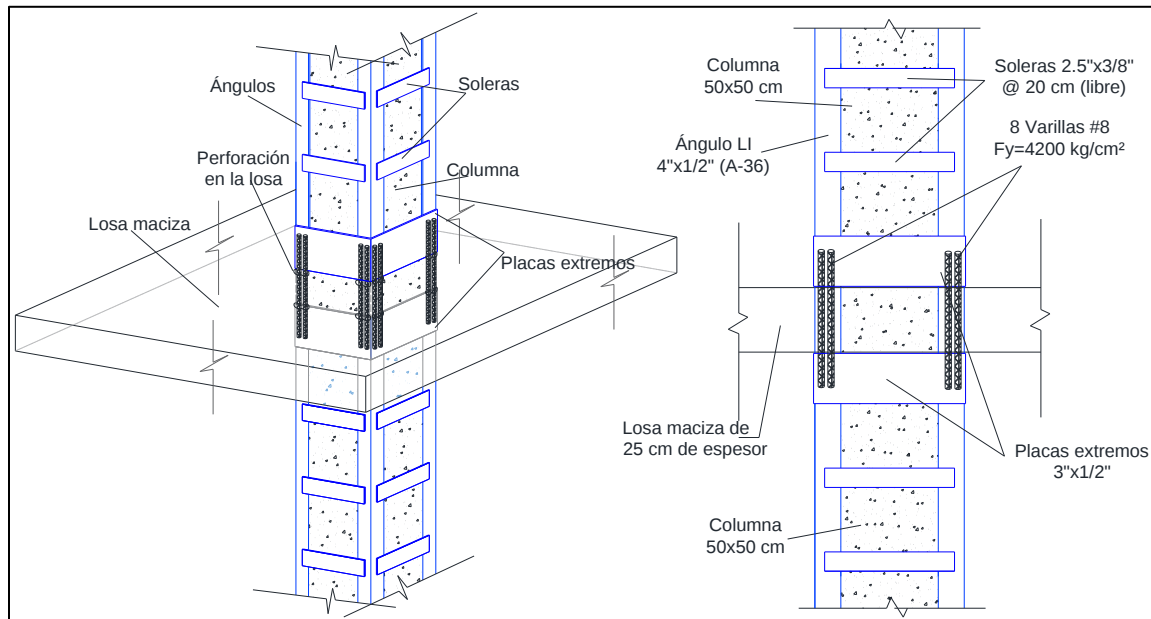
Continuidad de refuerzos de columnas con varillas atravesadas en la losa.
